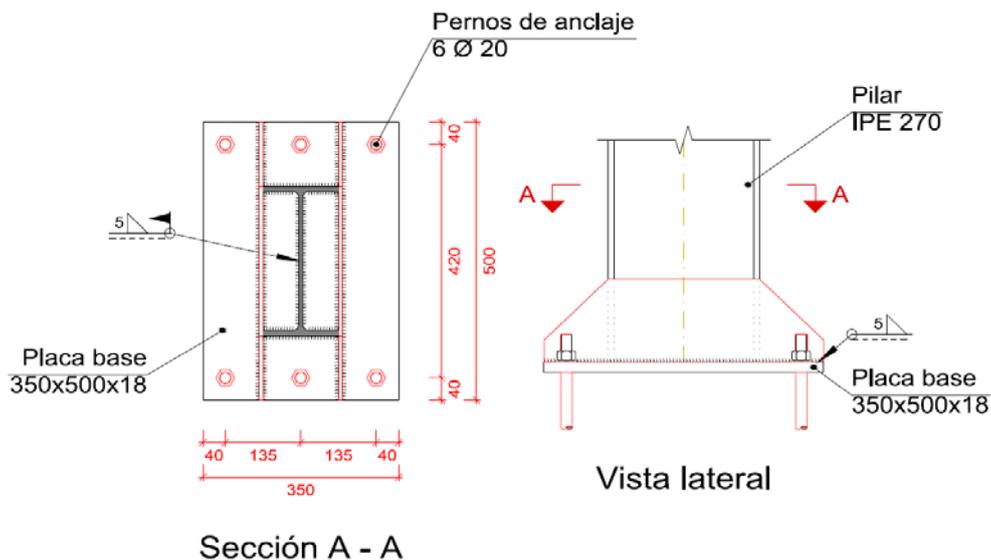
Placa de anclaje tipo 1 (fachada trasera).
